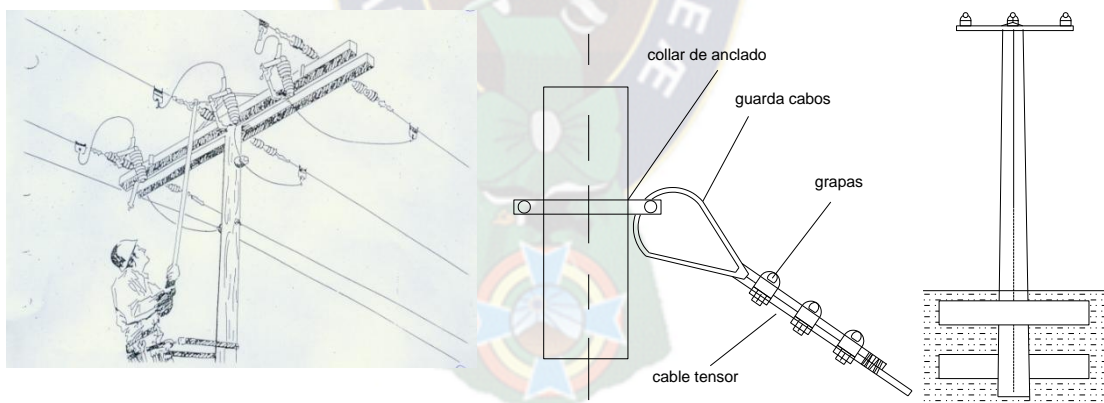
Apertura de Seccionador-Fusible, Fijación Riostra y Refuerzo en Poste.
